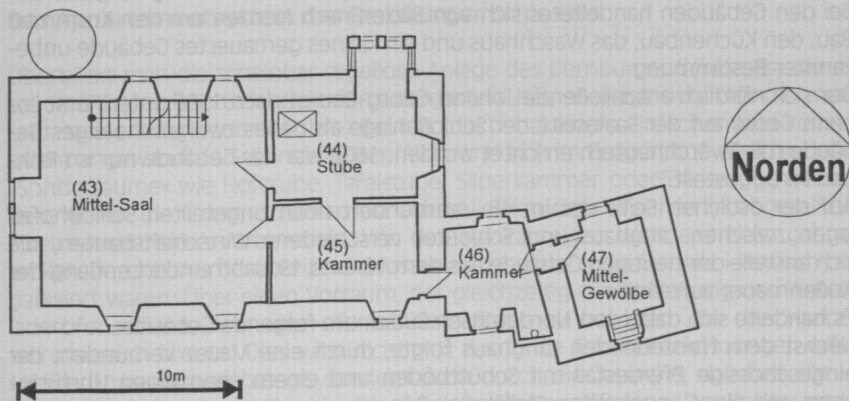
Altes Haus und Blauer Turm. Grundriß des zweiten Obergeschosses.
